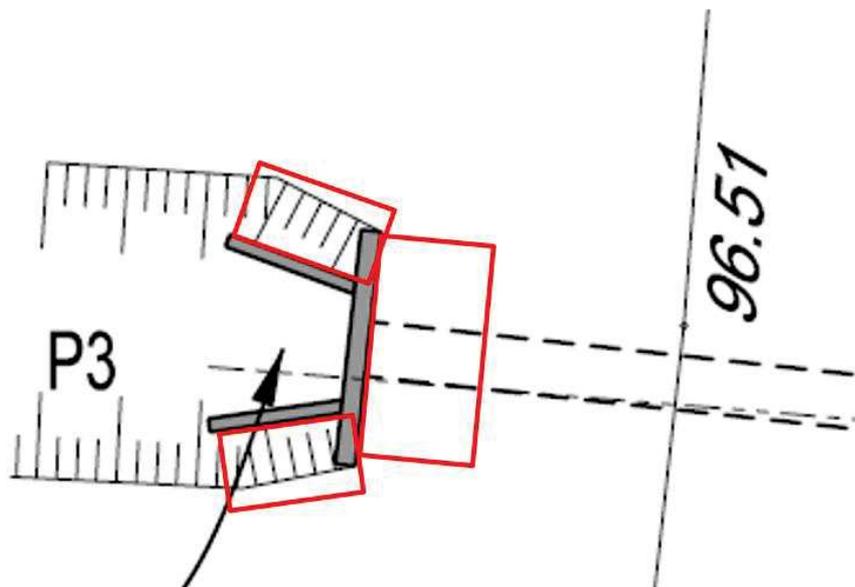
Emplacement du complexe filtre-drain autour de la conduite sous remblai
